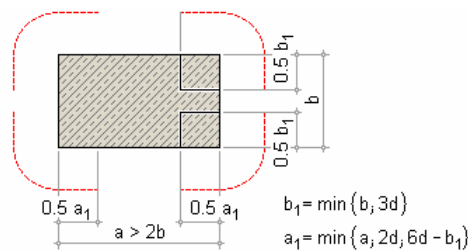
kritischer Rundschnitt bei ausgedehnten Auflagerflächen
